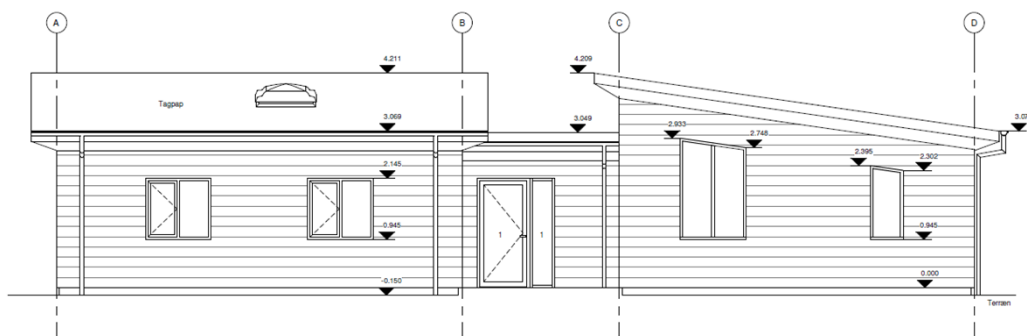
Nordvestlige facaden set fra adressen Sjellevej 76.
